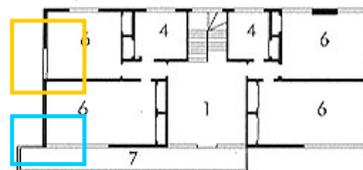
(1965) e 8b (2001): Planta do terraço-jardim.
